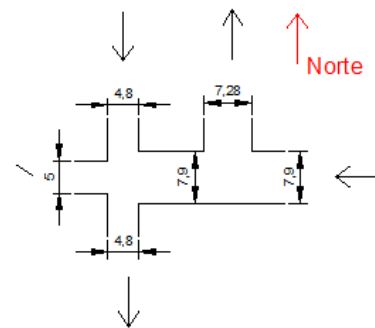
Esquema en planta del punto de estudio cruce calle 7 y carrera 15.
